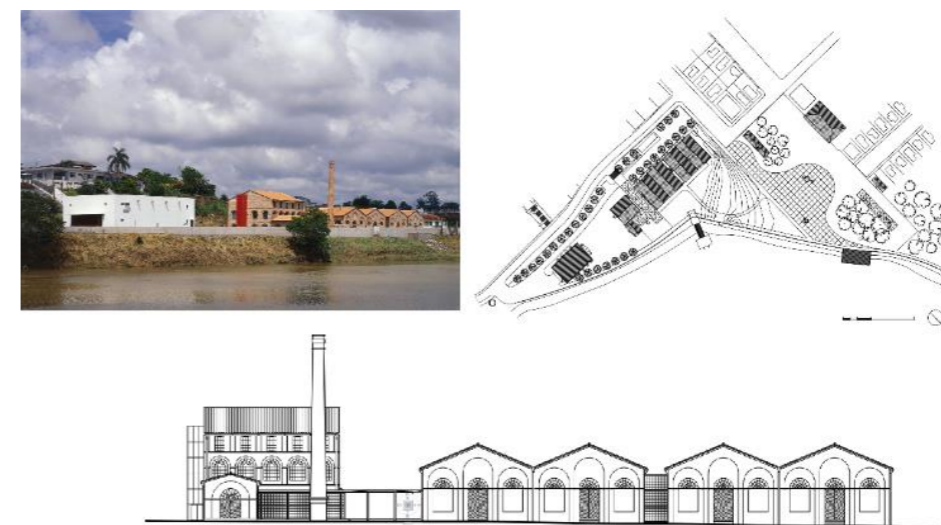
Foto do exterior, planta baixa e elevação do projeto do Conjunto KKKK. Fonte: (Brasil Arquitetura, 2005)
